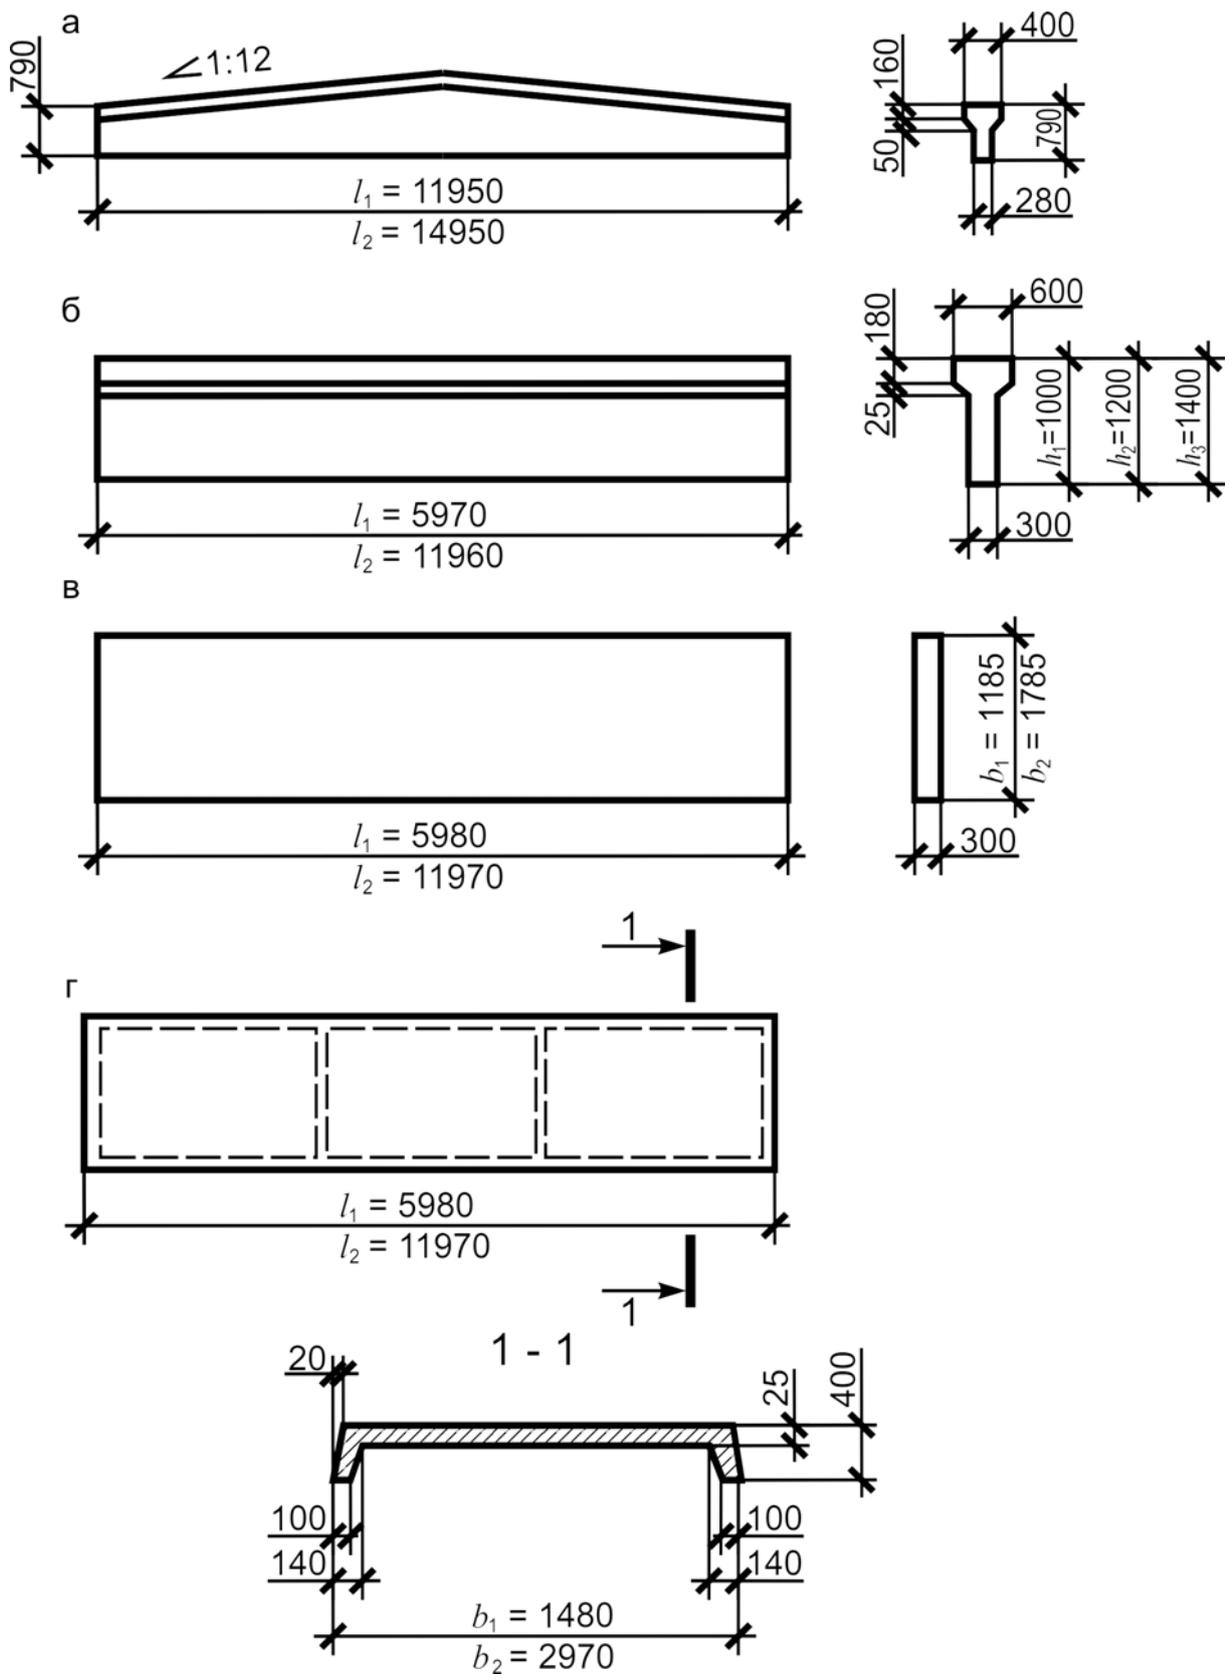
Балка покрытия (а), подкрановая балка (б), стенная панель (в), плита покрытия (г)
